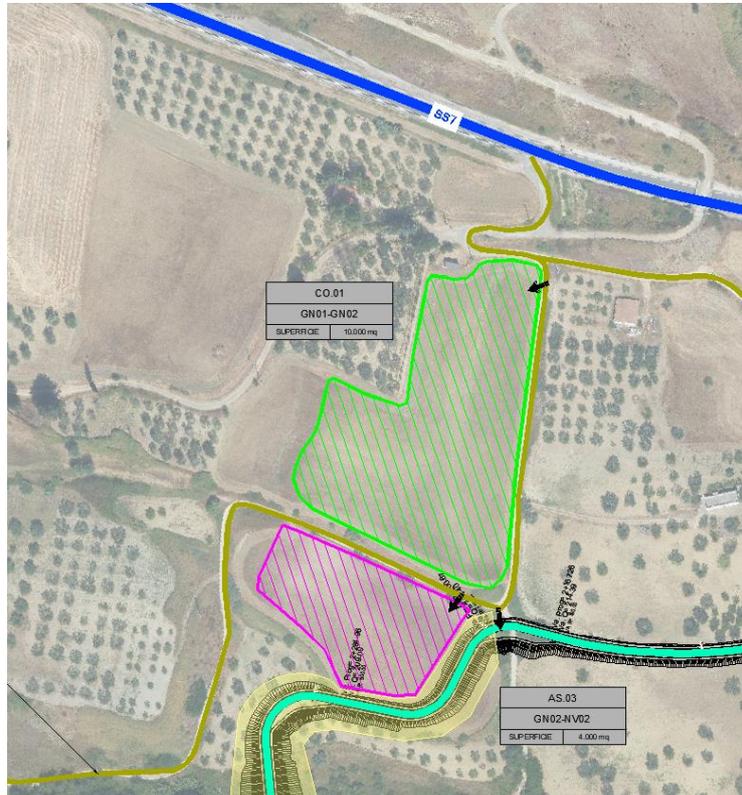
Ubicazione planimetrica del cantiere AS.03 (area magenta in basso)
